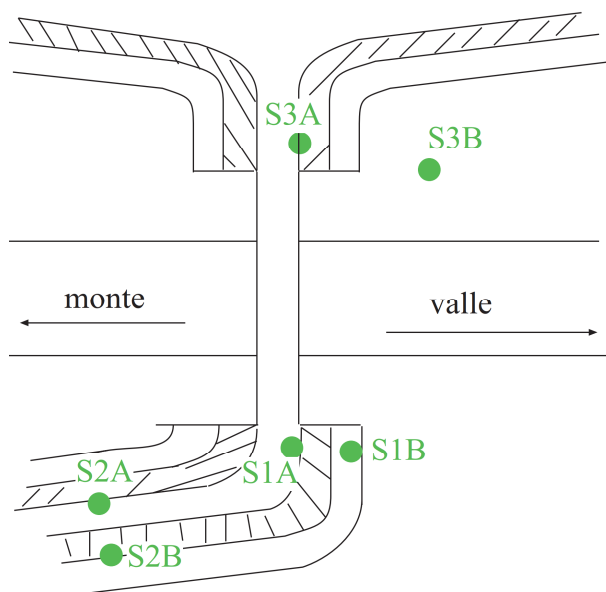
Stralcio planimetrico con ubicazione delle indagini svolte
